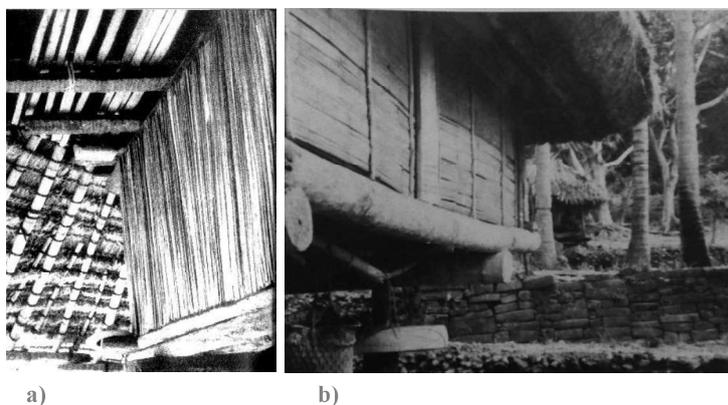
20. Paredes tradicionais. a) parede de palapa b) parede de bambu espalmado.
